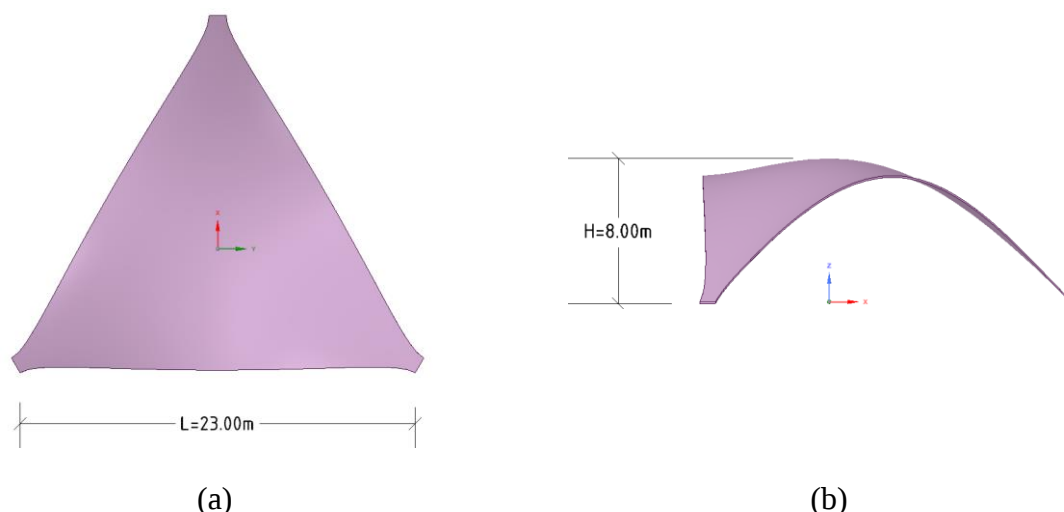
Dimensões da casca: (a) vista em planta; (b) vista lateral.
